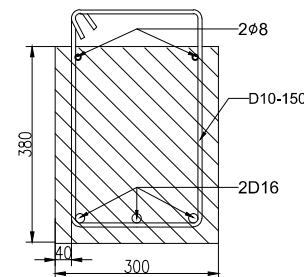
DETAIL PENGANGKATAN BALOK ANAK BENTANG 5m
